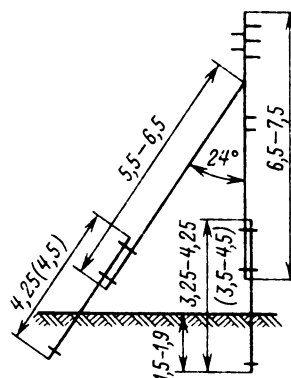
Деревянная анкерная угловая опора с железобетонными пасынками ВЛ 380 В
